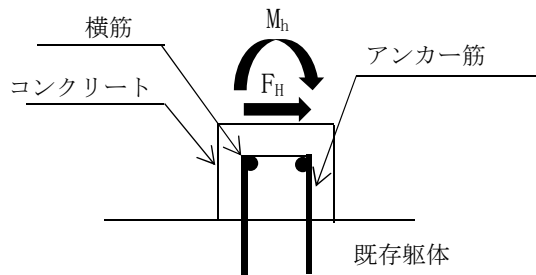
地震時の鉄筋コンクリート製堰に生じる力の断面概念図(矩形の堰)
